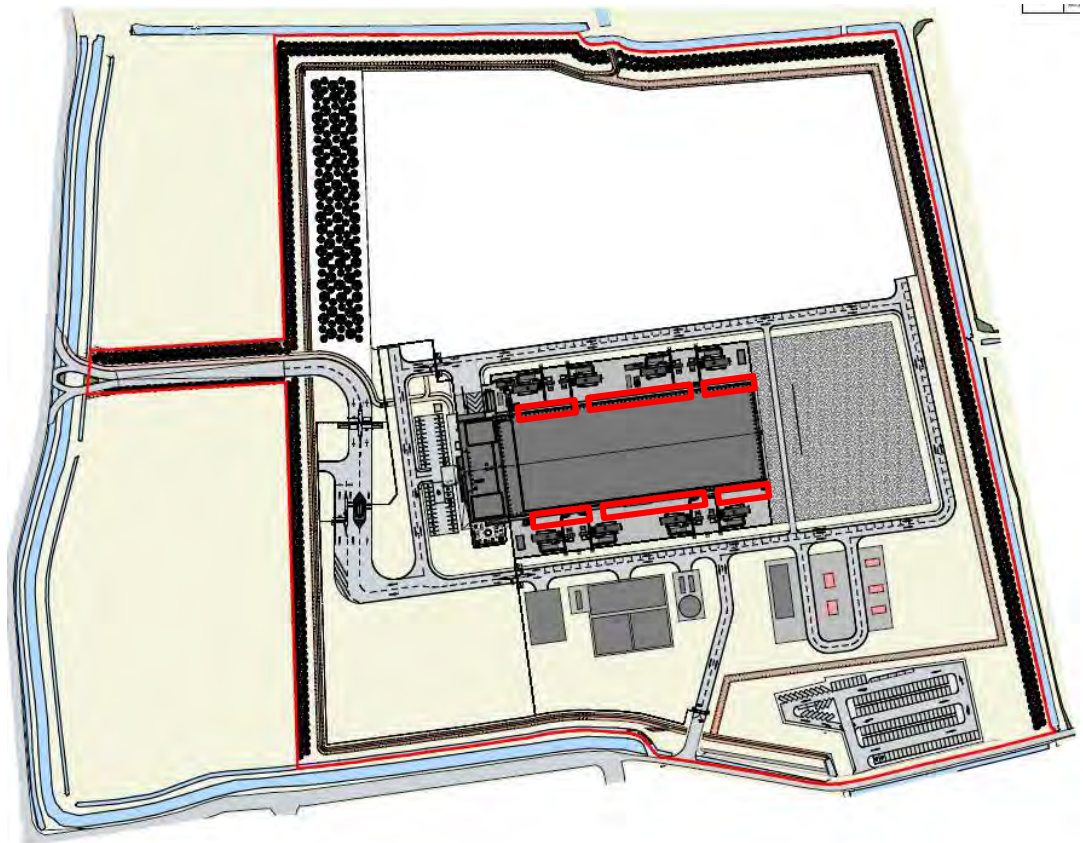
Planimetria MIL05 – posizione unità AHU (rosso)
